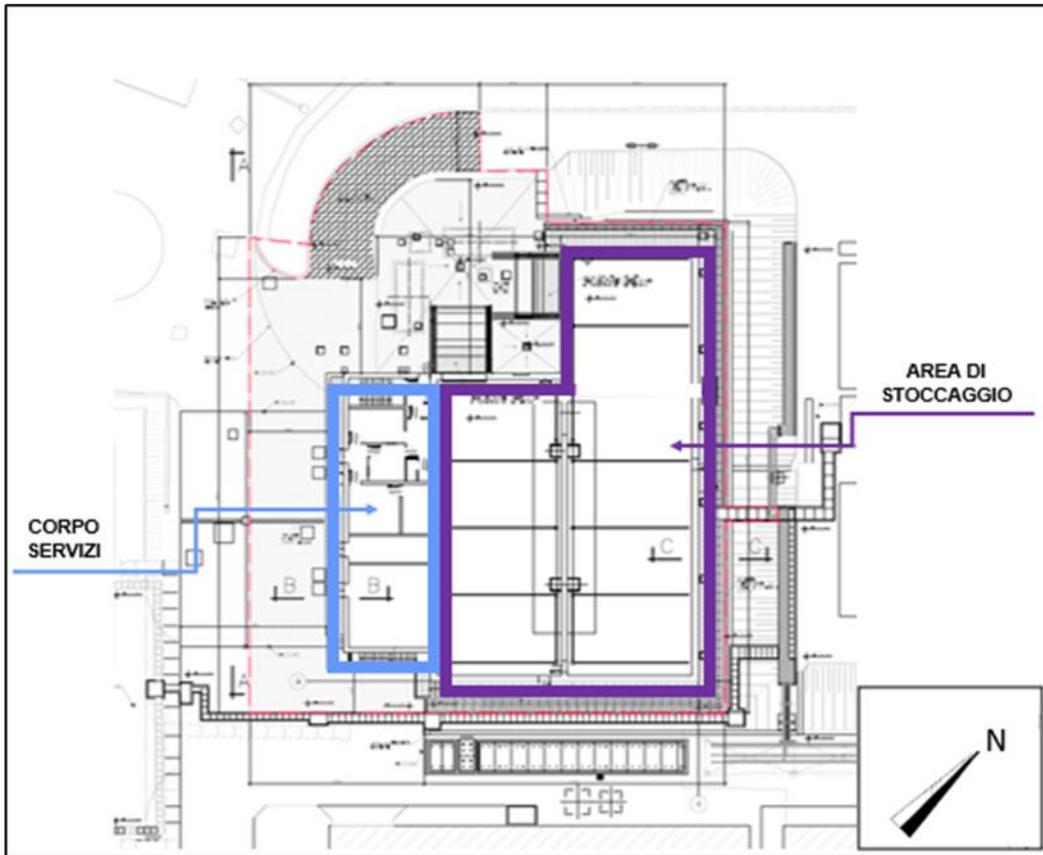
Nuovo deposito 2300: pianta del piano terra
